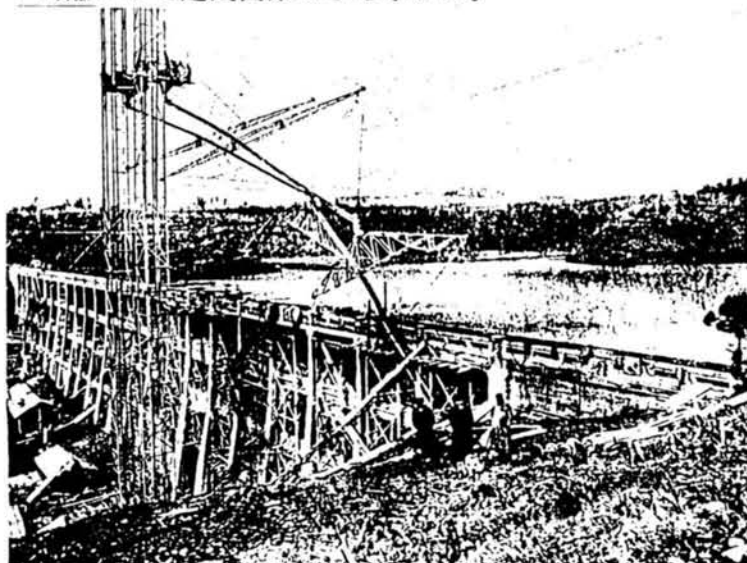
函館市上水道貯水堰堤施工状況<sup>17)</sup> (扶壁式鉄筋コンクリート堰堤の下流側)
